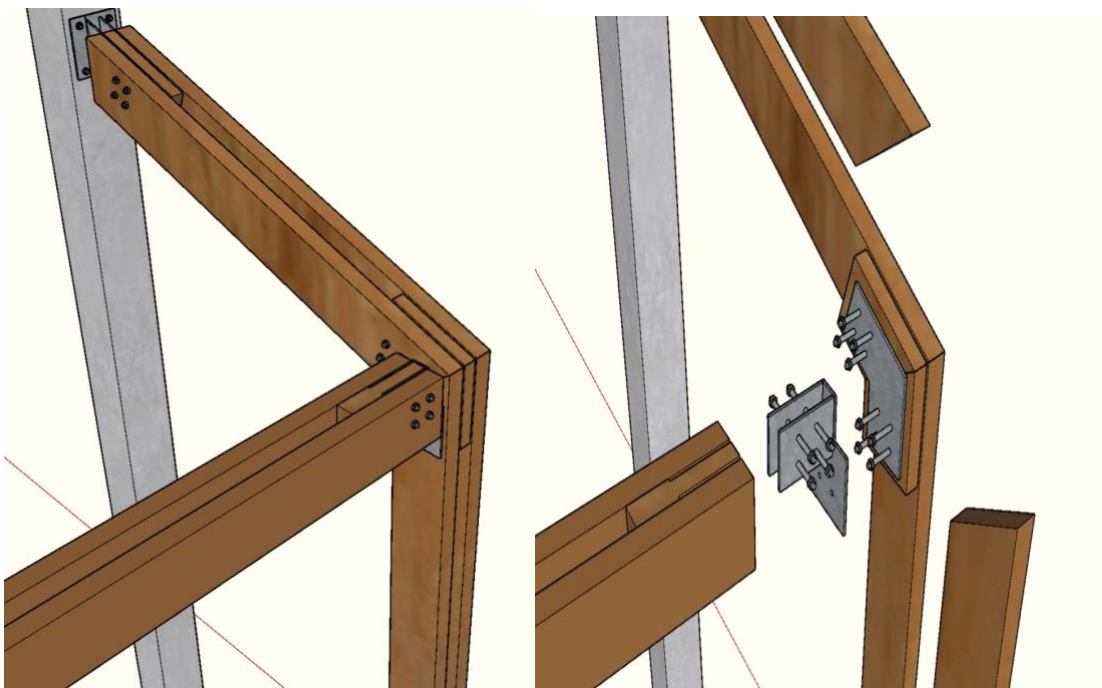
Unión columna viga en madera (Ver planos estructurales).
